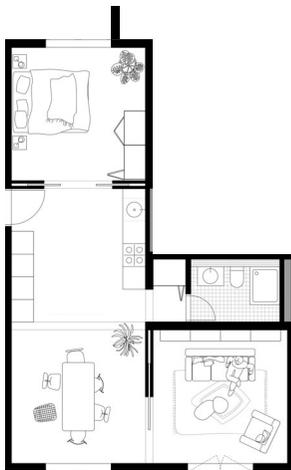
Grundriss einer Wohnung mit viereinhalb Modulen | Kirsten Schemel Architekten GmbH (Berlin)
